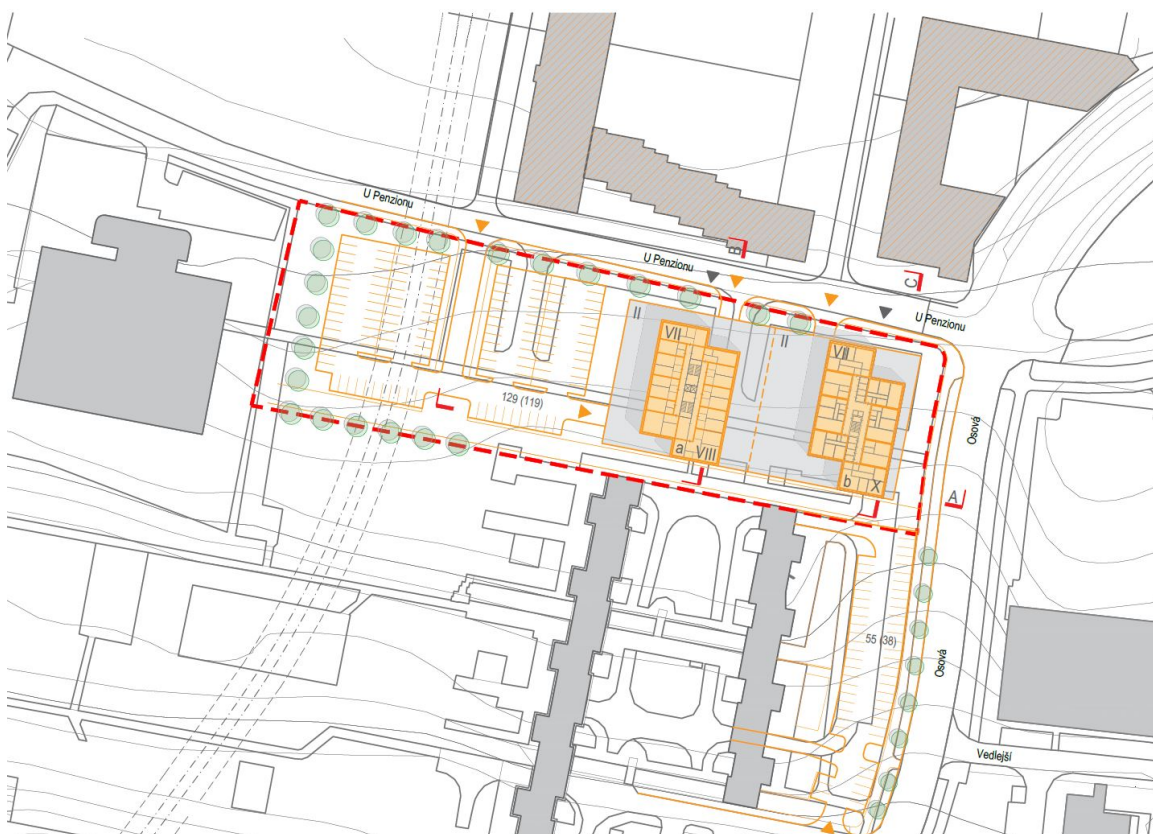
Stavební záměr "Městský blok Belle Rock" - výřez vizualizace
